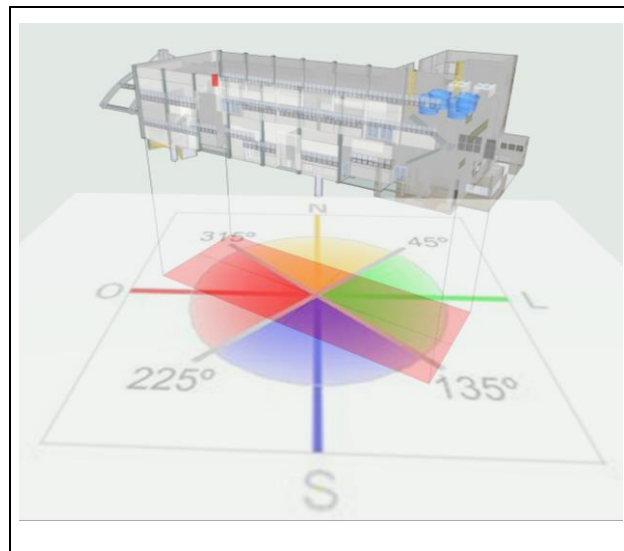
Orientação de fachadas – Sobreposição da edificação
